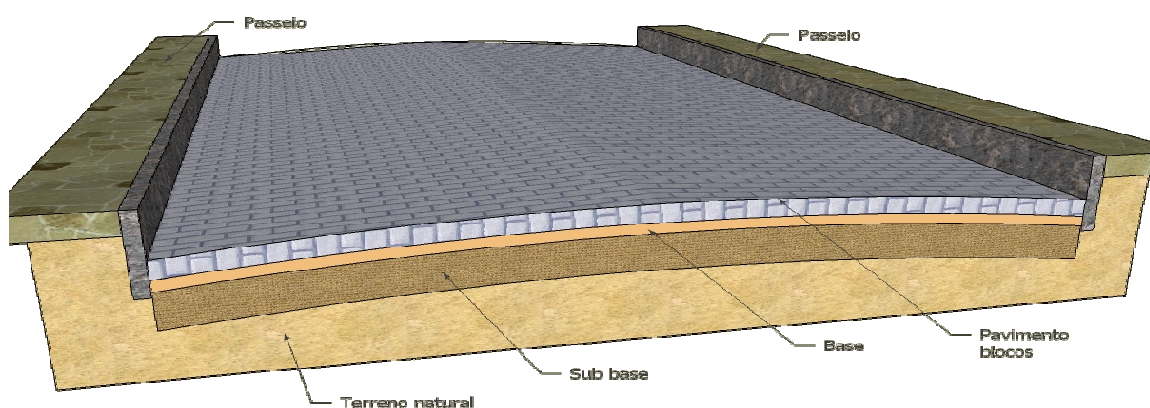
Desenho esquemático do perfil transversal da pavimentação
